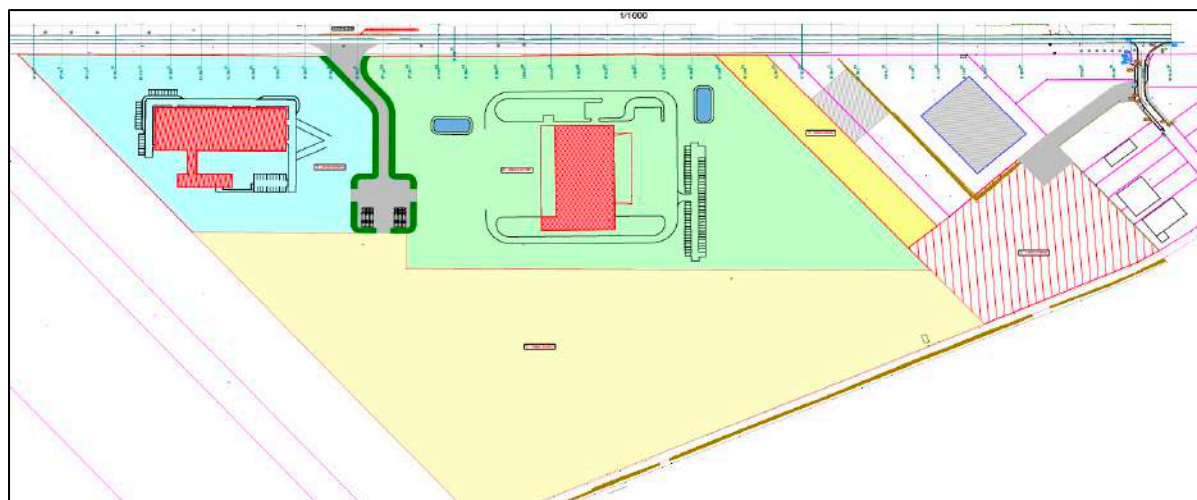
Plan APS 1 (accès haut) - (Source : Châlons Agglomération)
